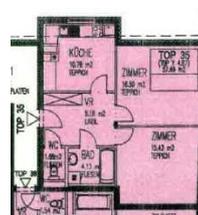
3-Zimmer Wohnung, getrennt begehbare Zimmer
